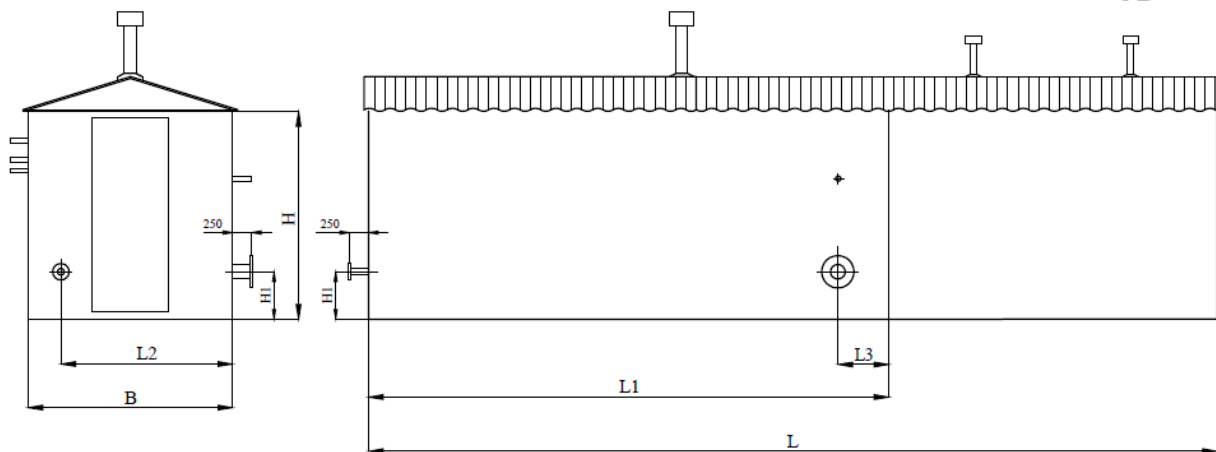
Габаритный чертеж ГРПБ. Исполнение 1
